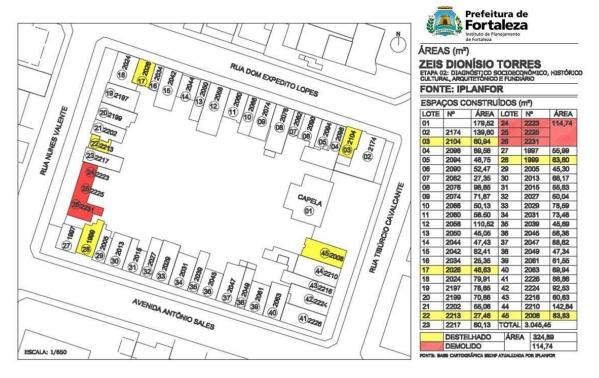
Áreas Lotes/Edificações Vila Vicentina base em Autocad. Fonte: IPLANFOR, 2020
